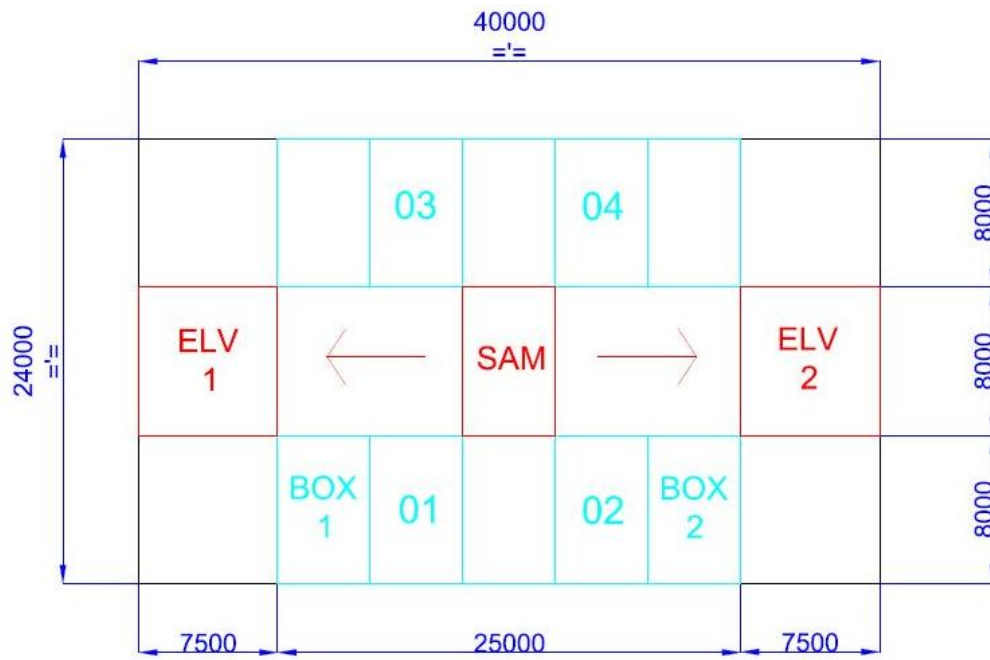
Layout de la Planta 0 del aparcamiento.
